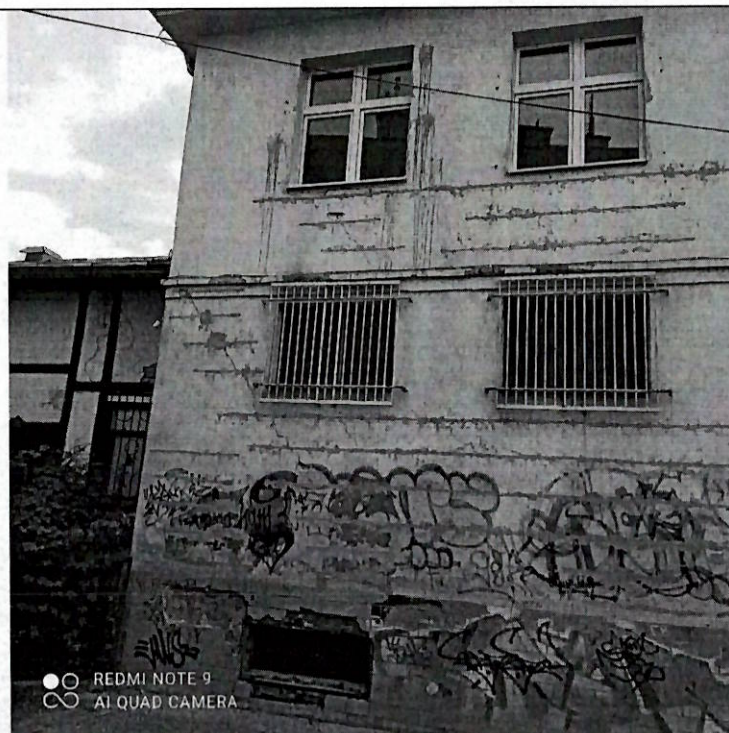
Wyeksploatowana drewniana stolarka okienna w bud. hotelowo-biurowym
